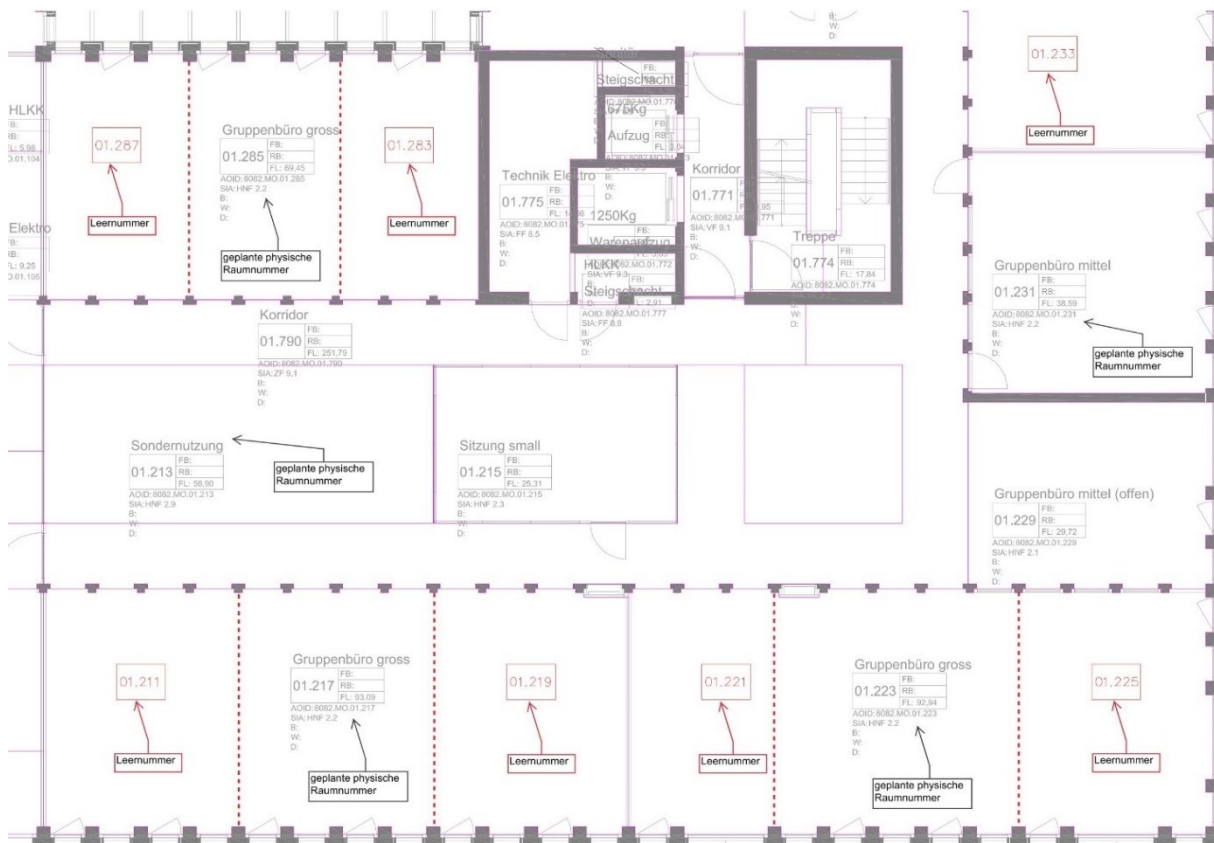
Bsp. Grundriss mit Leernummernvergabe – Leernummern in Rot abgebildet
